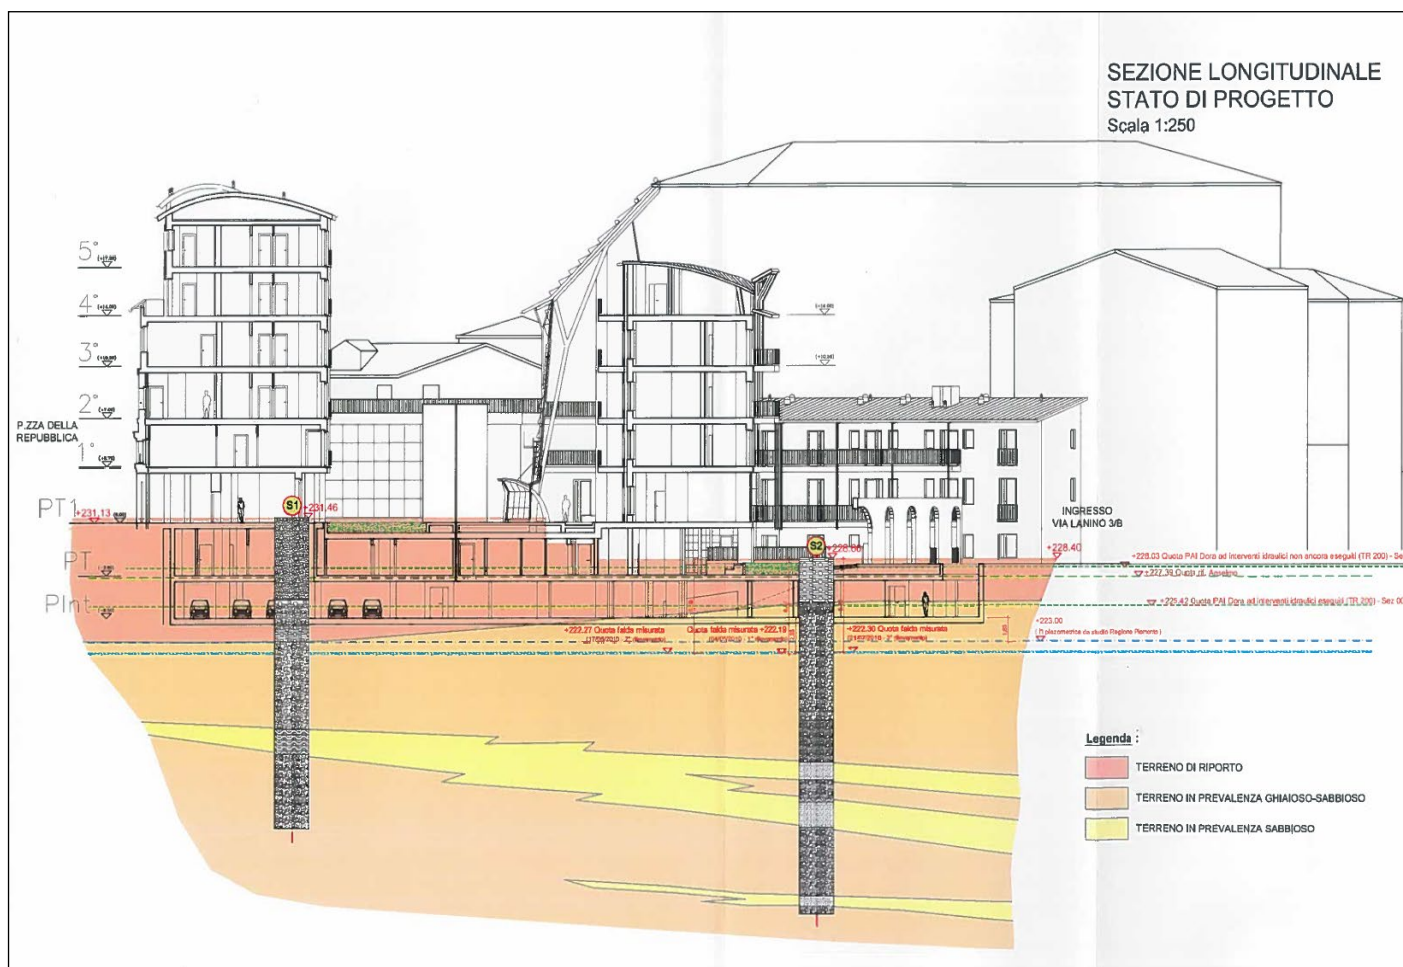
SEZIONE LONGITUDINALE STATO DI PROGETTO
